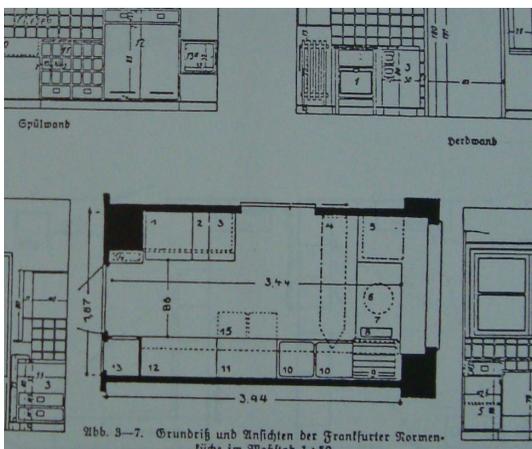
Margarete Schütte-Lihotzky, planta, corte, e elevações internas da cozinha de Frakfurt
